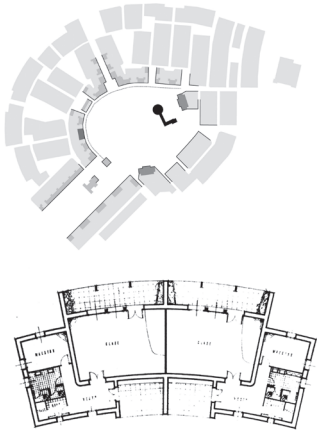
Grupo escolar de Entrerriós (Badajoz, 1955), por Alejandro de la Sota. Arriba: esquema de posición de las instituciones fundamentales en el centro cívico (elaboración propia); abajo: planta de las escuelas de Entrerriós. Fuente: Arch. Ministerio de Agricultura.
